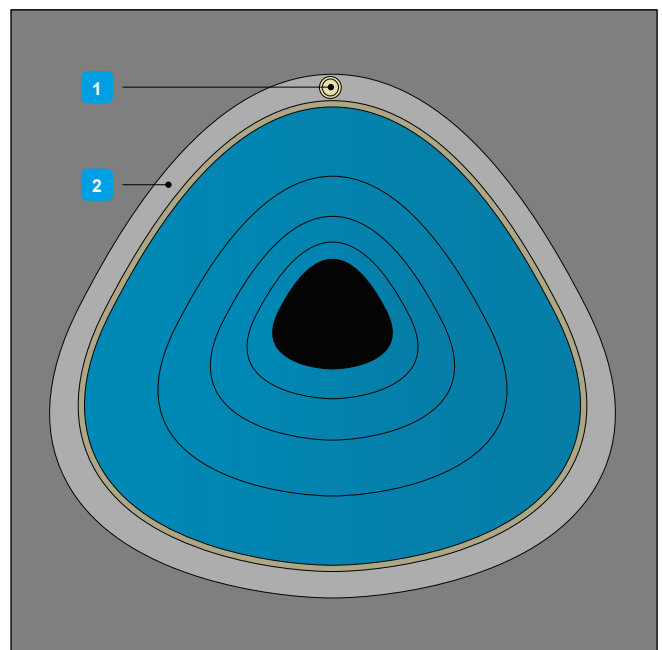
Coupe d'une section de canalisation avec trou d'évacuation d'air | Légende : 1 - trou d'évacuation d'air ; 2 - Coulis
